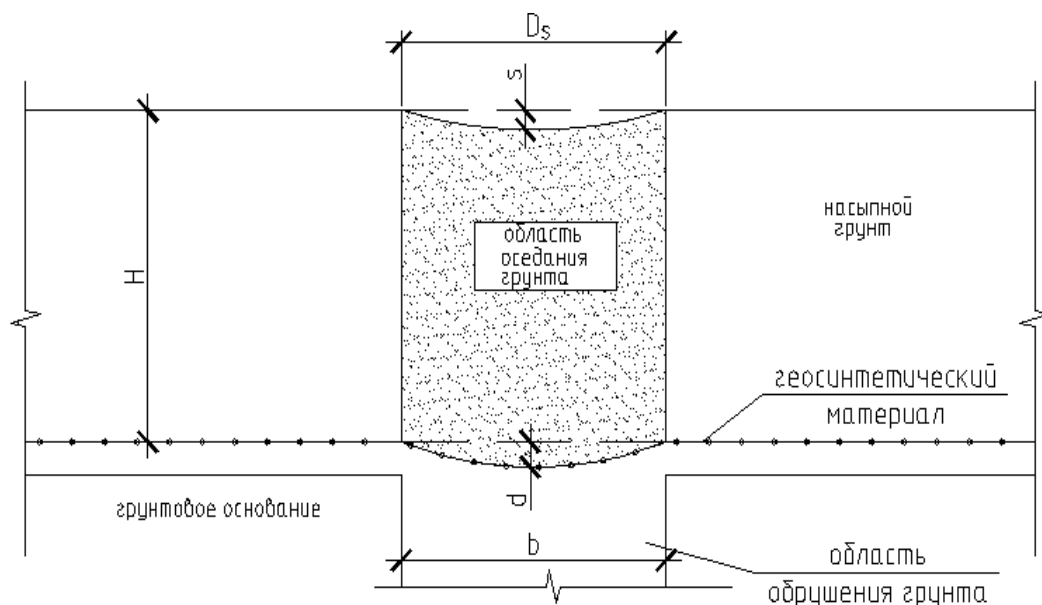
Схема метода Giroud: d – прогиб геосинтетики; H – высота насыпи над армирующим слоем; s – осадка поверхности, D_s – ширина области провала грунта
